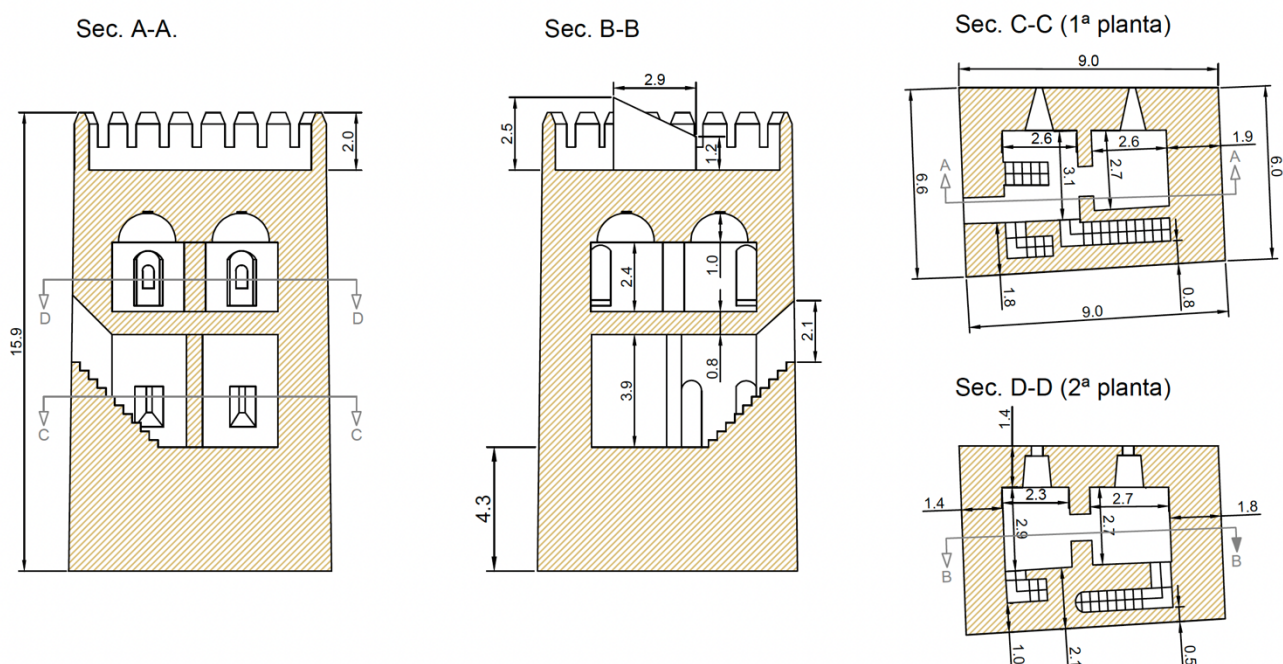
Geometría de la Torre de Muhammad. Principales dimensiones (en metros).
